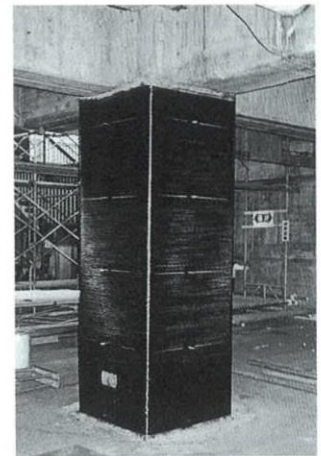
炭素繊維ストランドを巻いた柱 Jacketing by CF Strands
